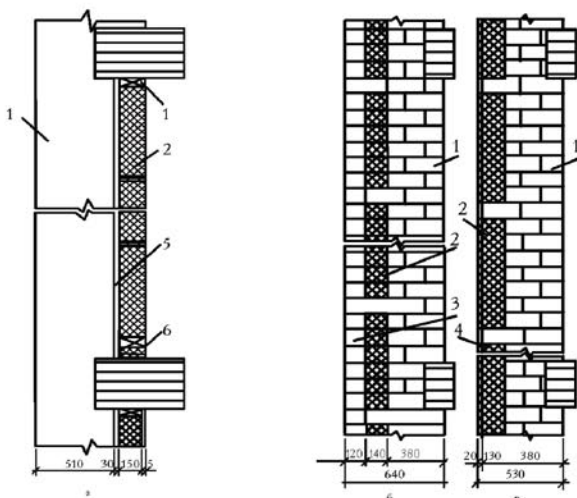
Утепление наружных стен по строительной системе "Пенобетон-утеплитель": а — утепление с внутренней стороны; б — утепление с наружной стороны и облицовка кирпичом; в — утепление с внешней стороны и декоративной штукатуркой; 1 — несущая часть стены; 2 — плиты утеплителя; 3 — облицовочный кирпич; 4 — декоративная штукатурка; 5 — воздушная прослойка; 6, 7 — отверстия притока и вытяжки соответственно
